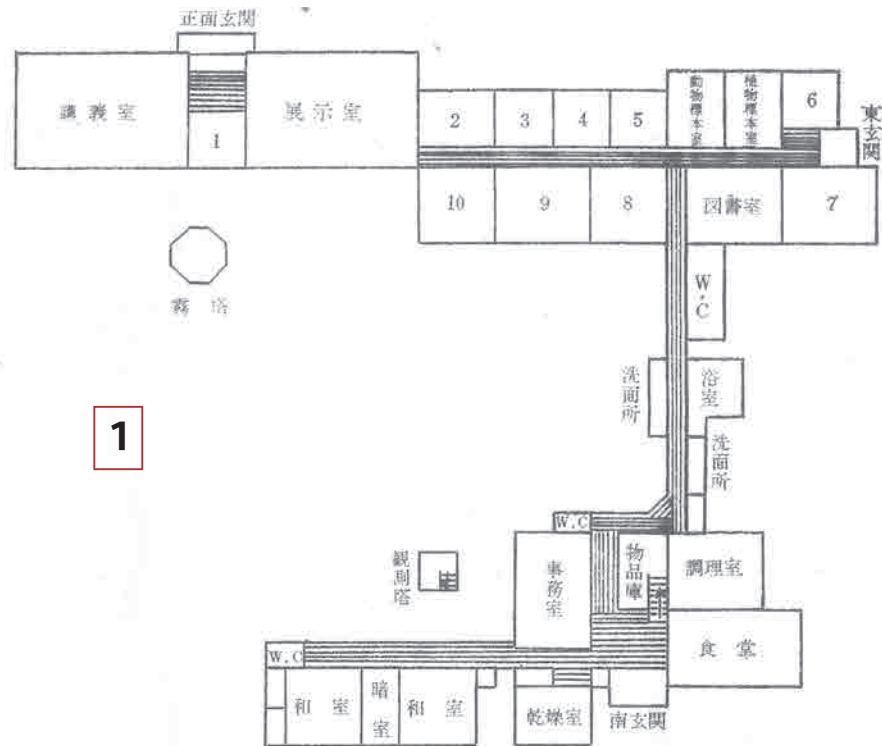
菅平高原生物実験所 実験研究棟 平面図
